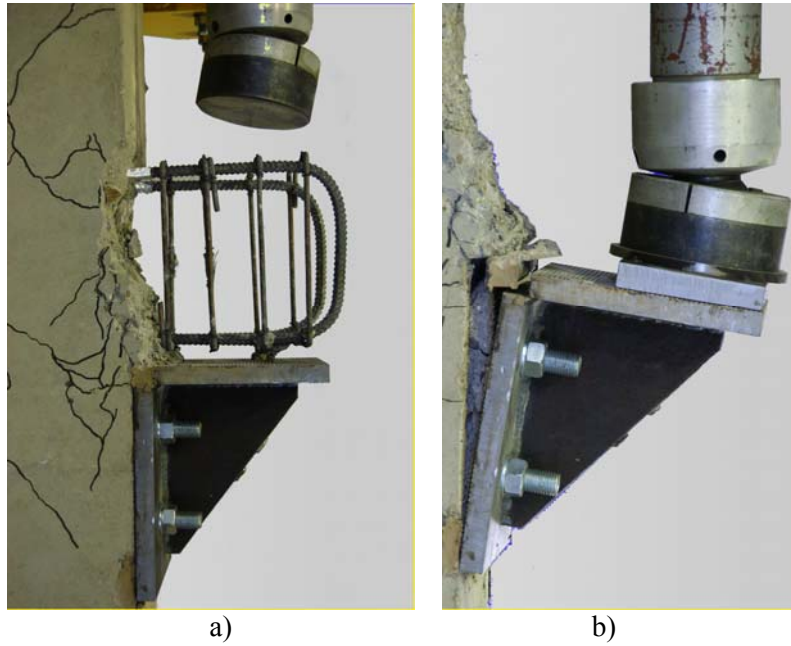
Konstrukcja elementów serii F (szczegóły patrz załącznik)
